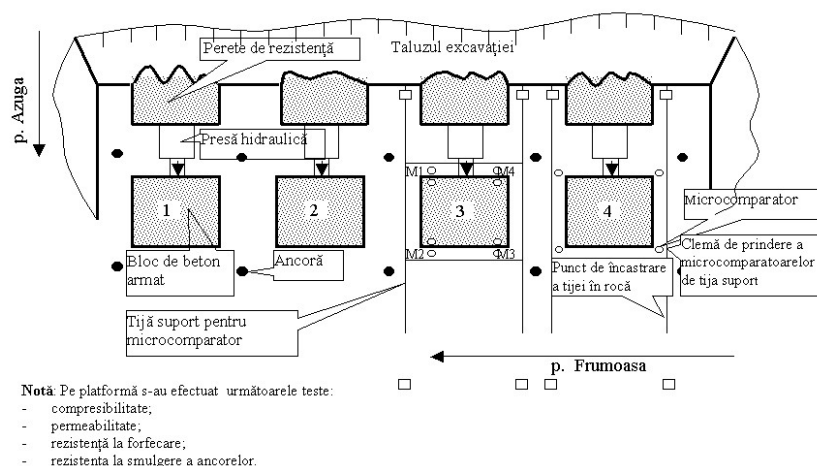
Amplasarea în plan orizontal a ancorelor și a blocurilor de beton armat pentru testul compresibilitate și forfecare beton - rocă
